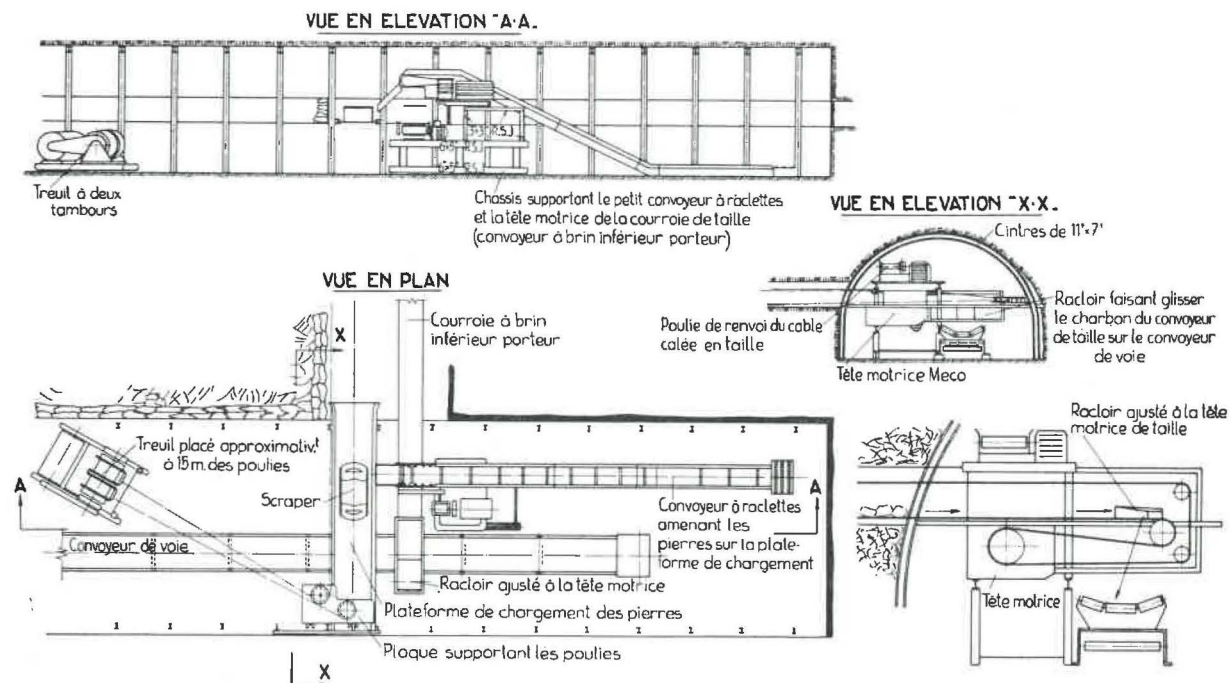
Remblayage par scraper des pierres du bossement d'une voie de base avec coupage du mur. On remarque la disposition des installations de transport et de l'estacade pour ramener les pierres en taille.
